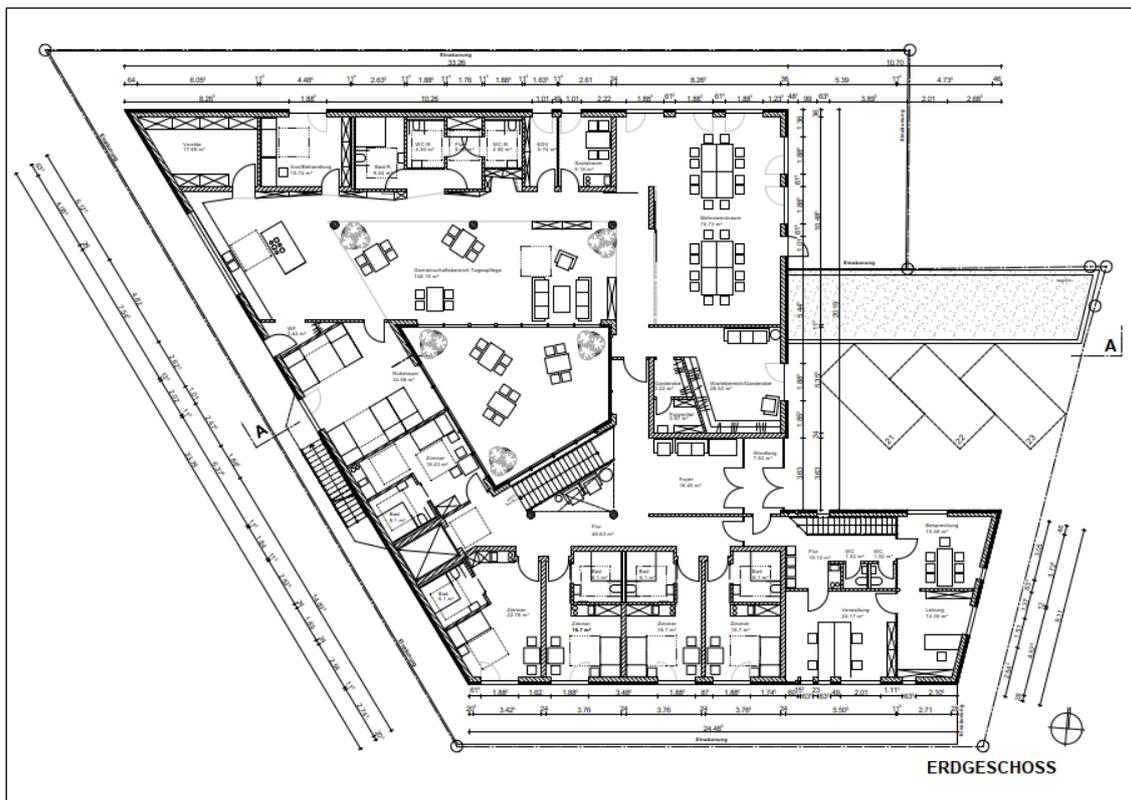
Grundriss des Erdgeschosses /13/
